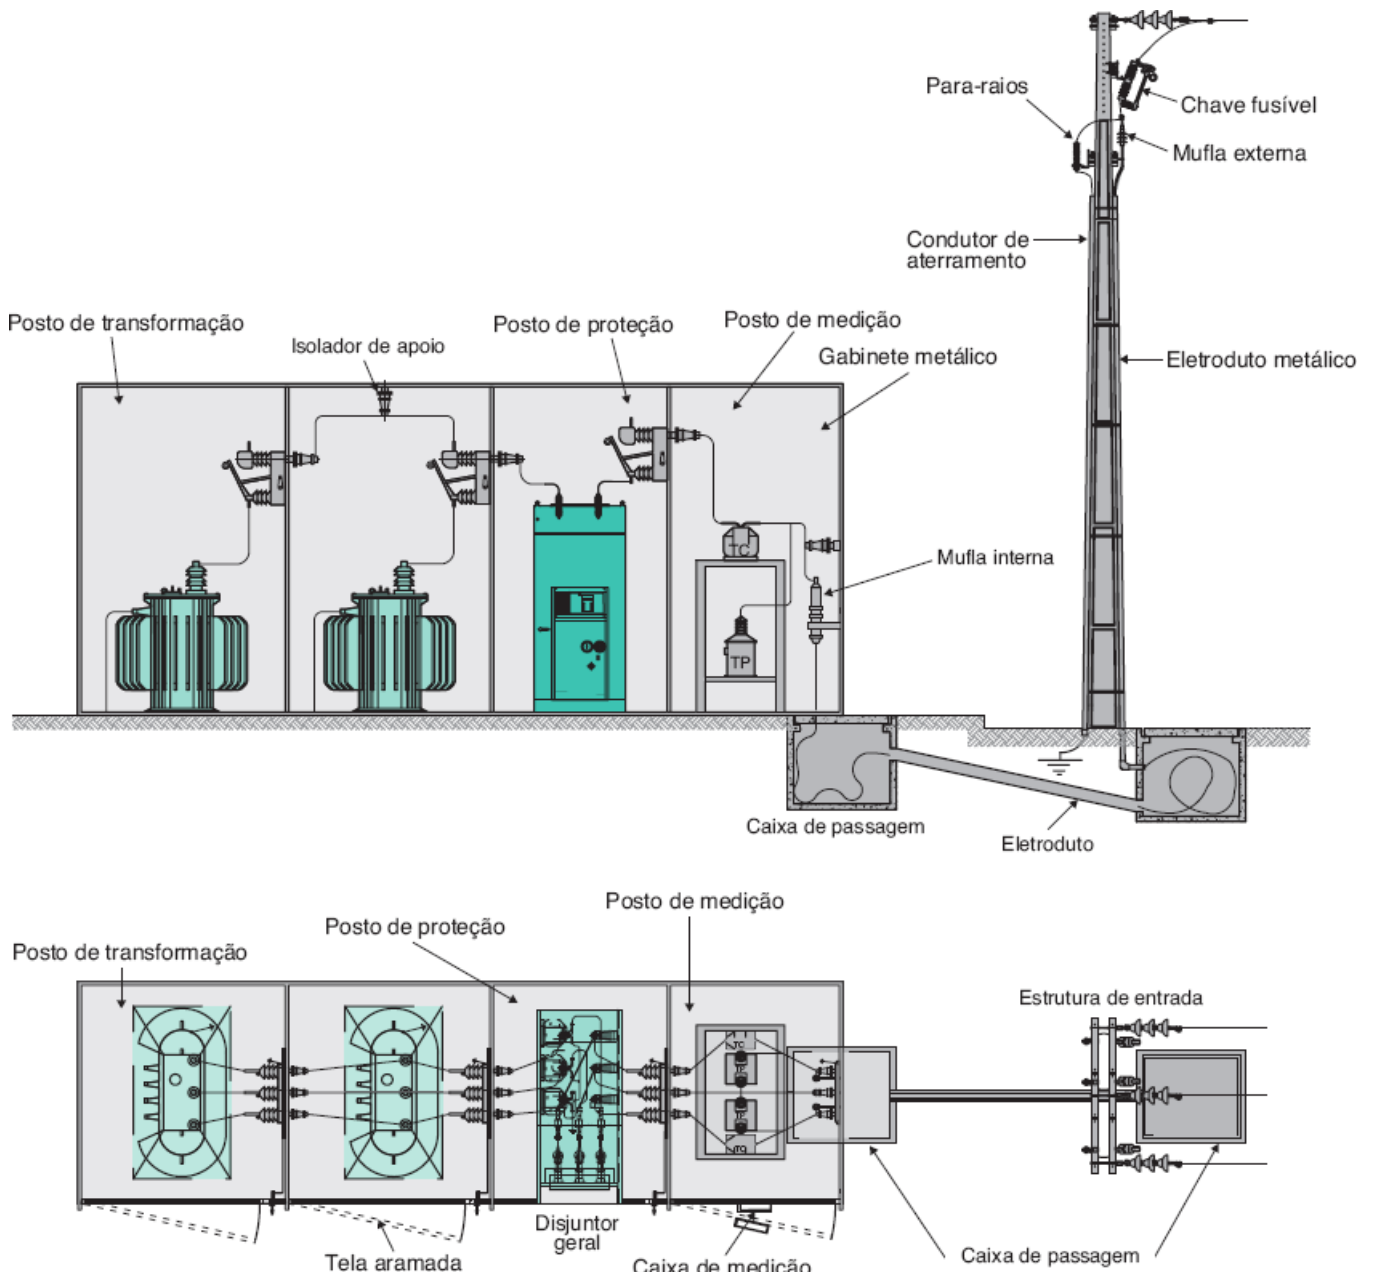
Vistas frontal e superior de uma subestação modular metálica em chapa de aço.
